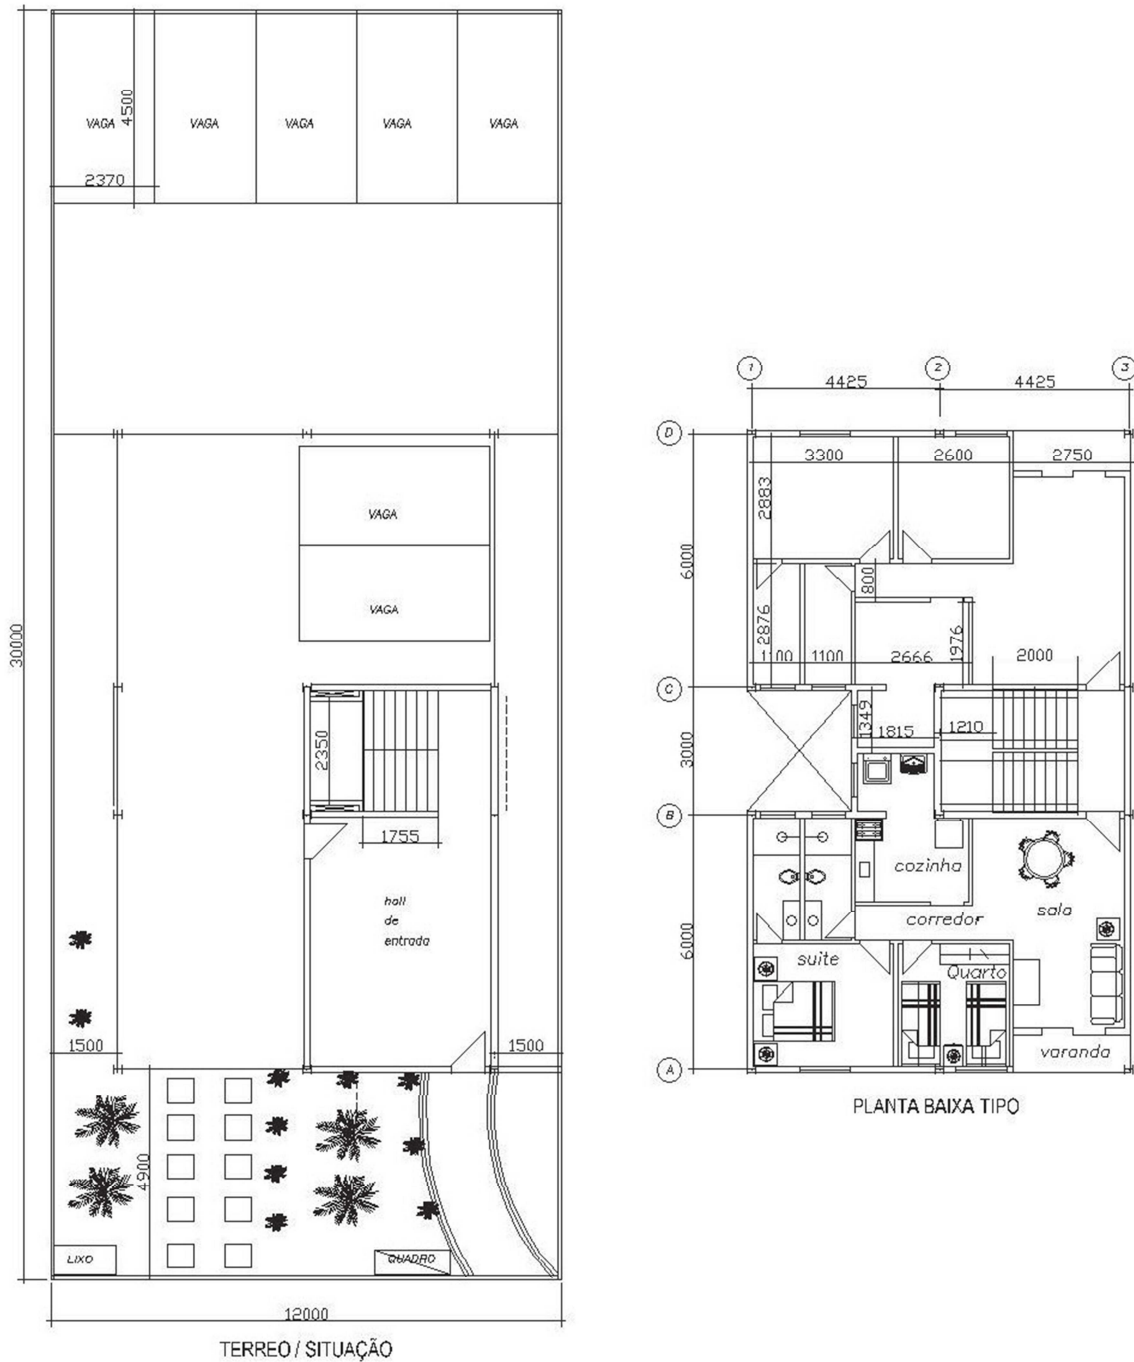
1 – Planta Situação e Planta Pavimento Tipo
